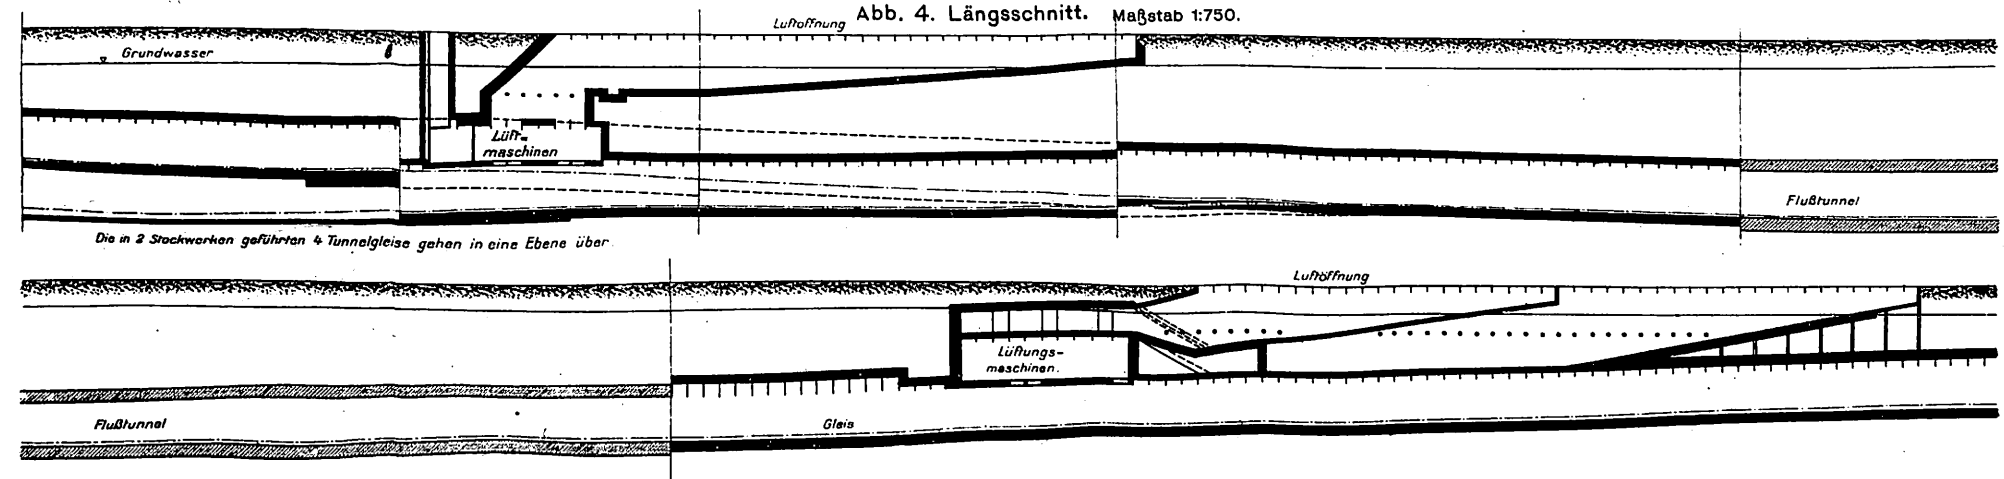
und 4. Tieftunnelstrecken der Lexington-Avenue-Untergrundbahn unter dem Harlem-Fluße.
